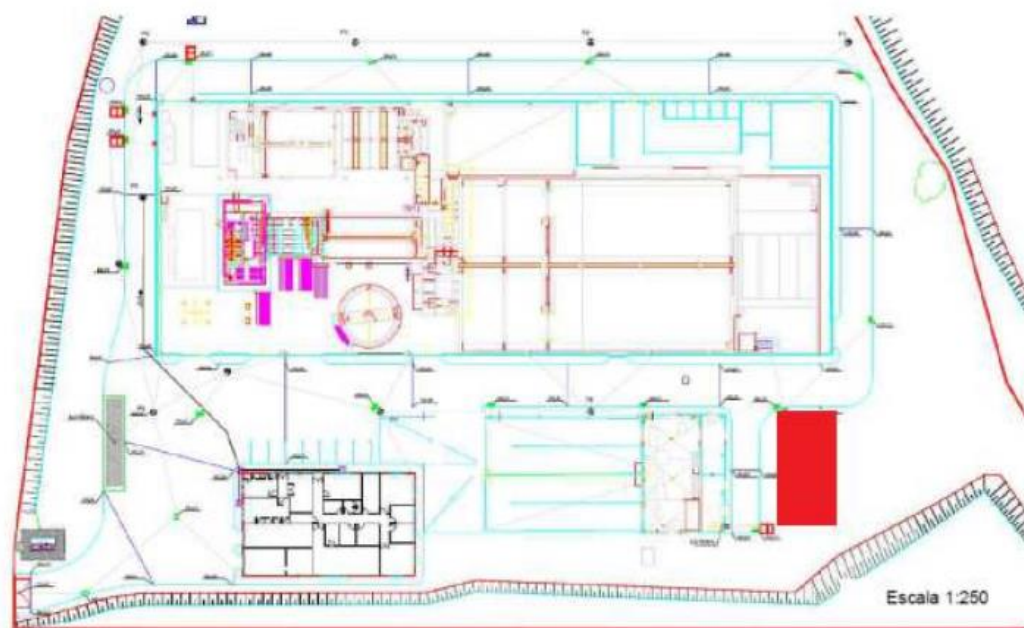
Plano planta EDAR. Ubicación nuevo edificio.
